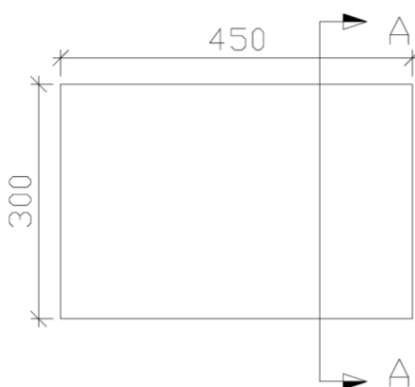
Vista superior do aparelho de apoio (medidas em mm)
